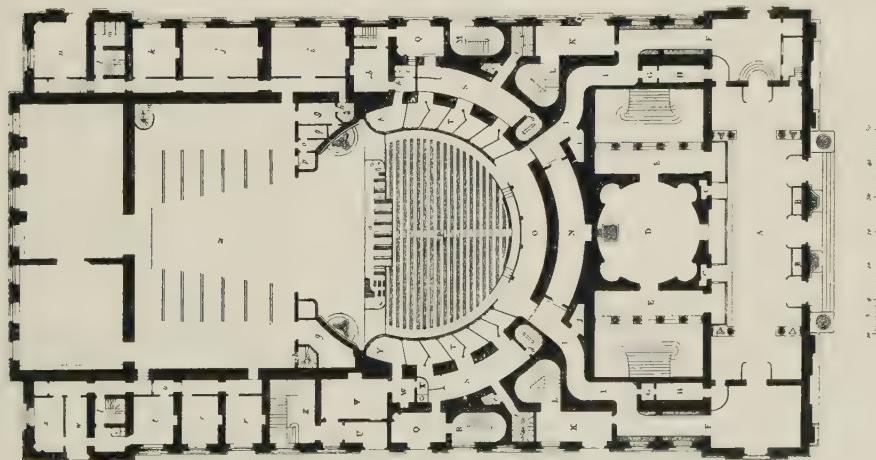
Das Drury-Lane-Theater in London Grundriß
